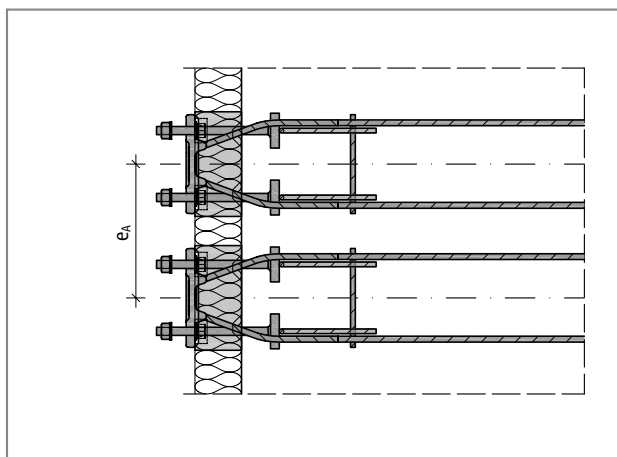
Schöck Isokorb® T tipo SQP: distanza assiale
